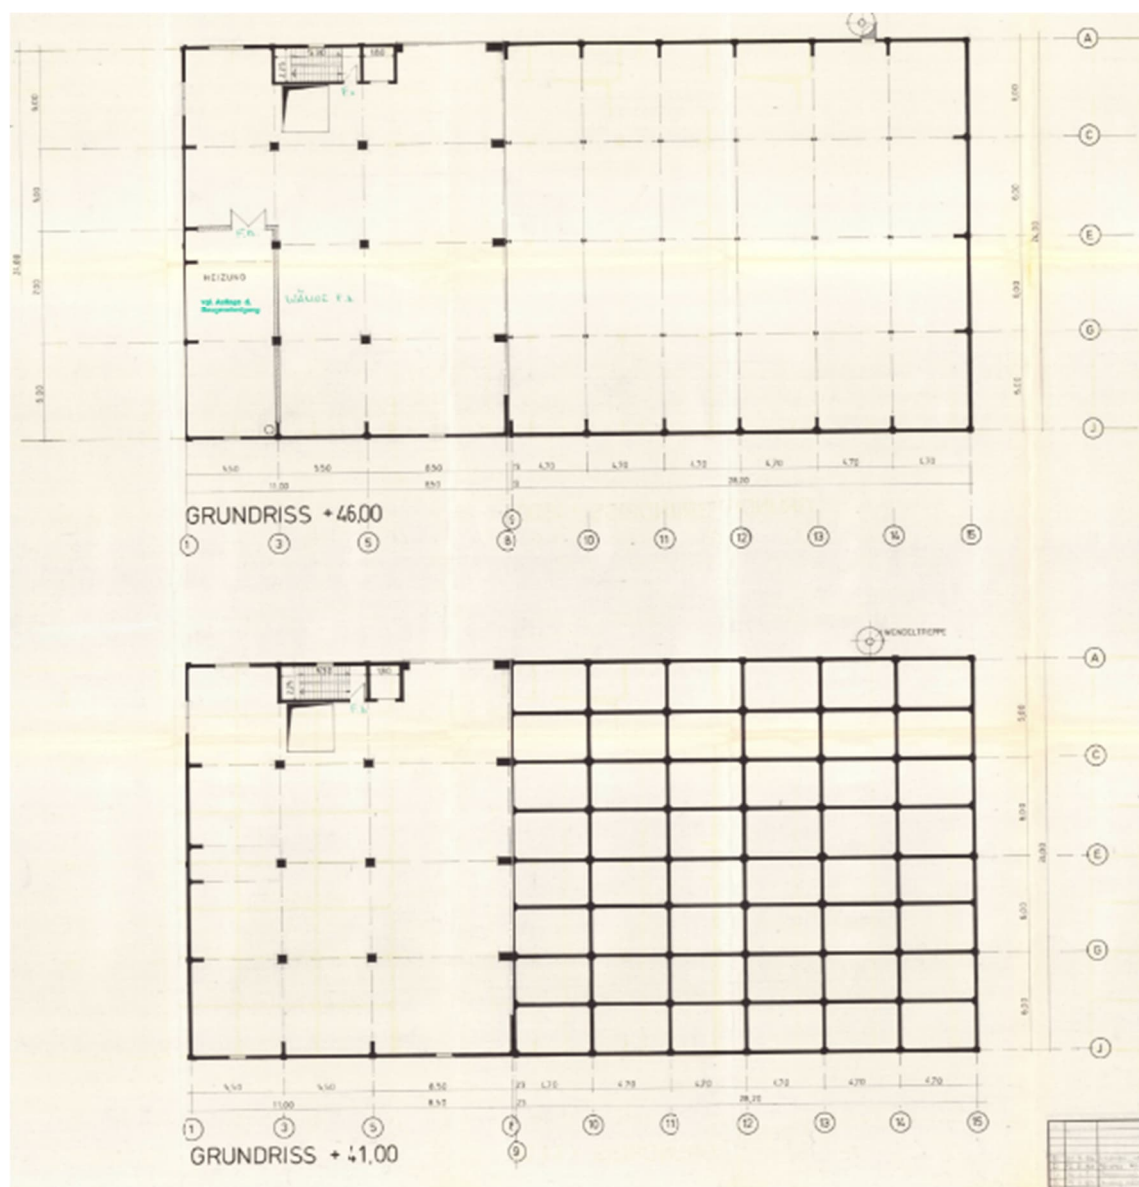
Bestandsgrundrisse Obergeschosse Gebäude A1
